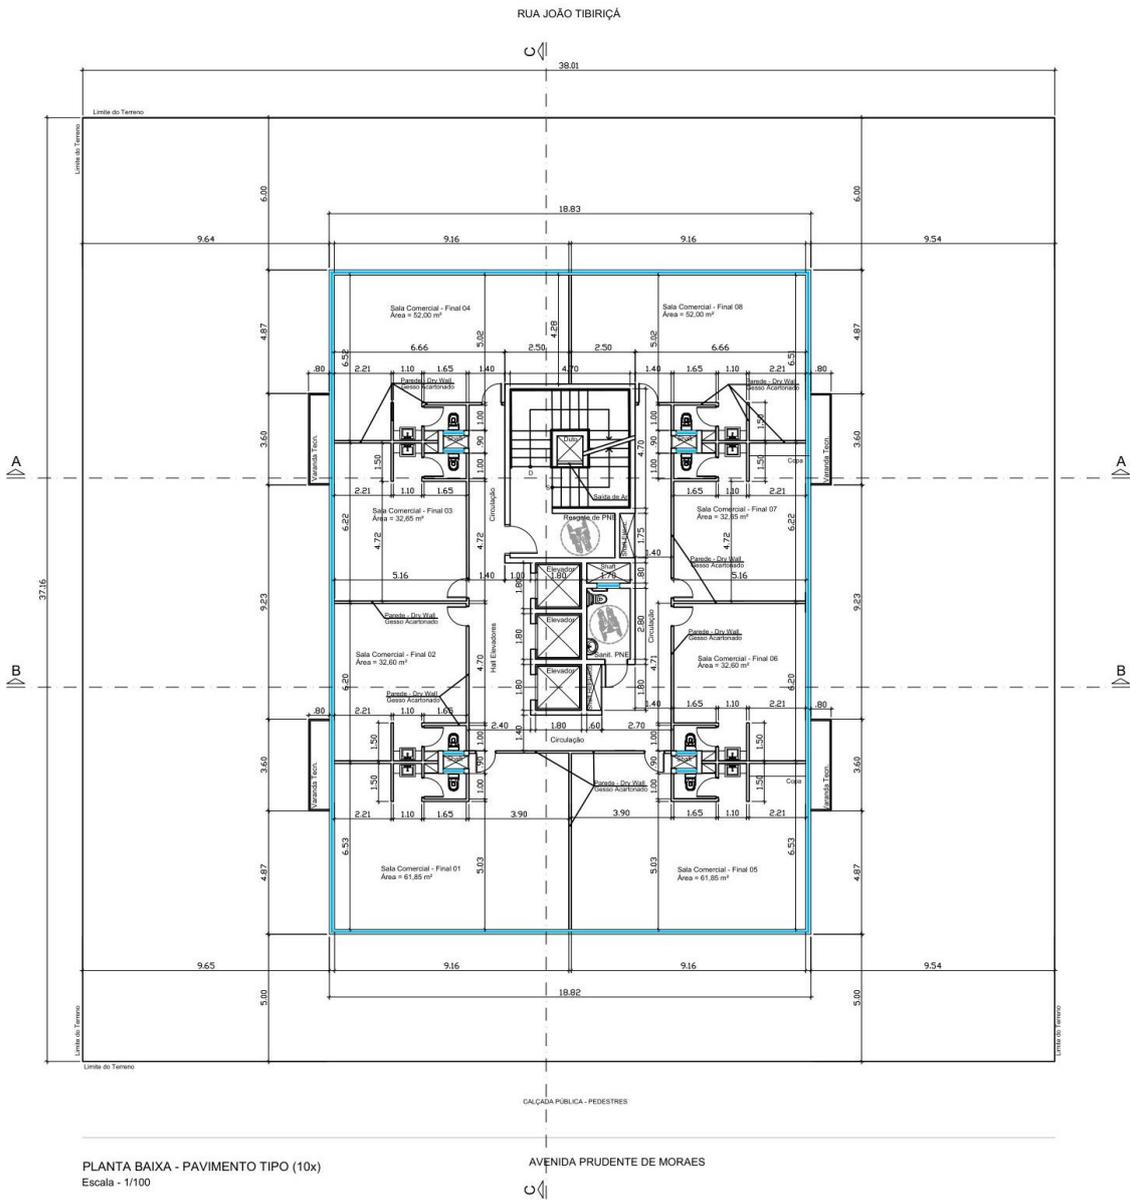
Projeto de implantação do empreendimento: pavimento tipo (2º ao 11º andar).
